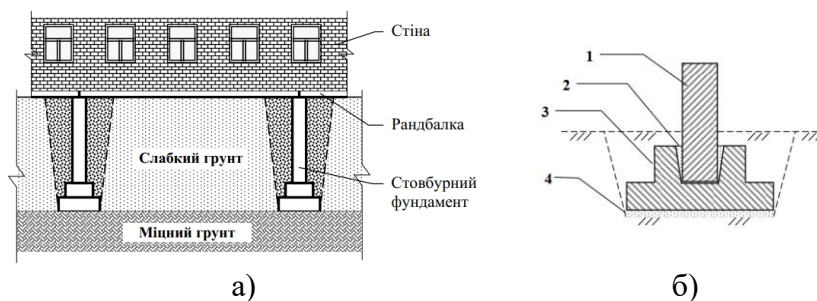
Приклад конструкції стовбурних фундаментів: звичайного (а) та стаканного (б) типу: 1 – колона; 2 – бетон; 3 – фундамент під колону (підколонник); 4 – бетонна підготовка
